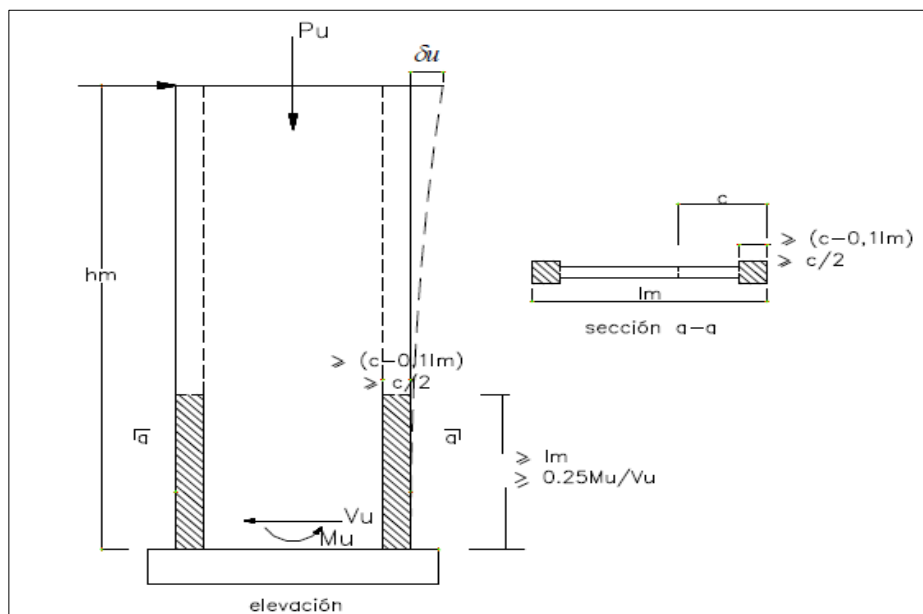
Elementos confinados de borde en muros. Fuente. Norma E.060
